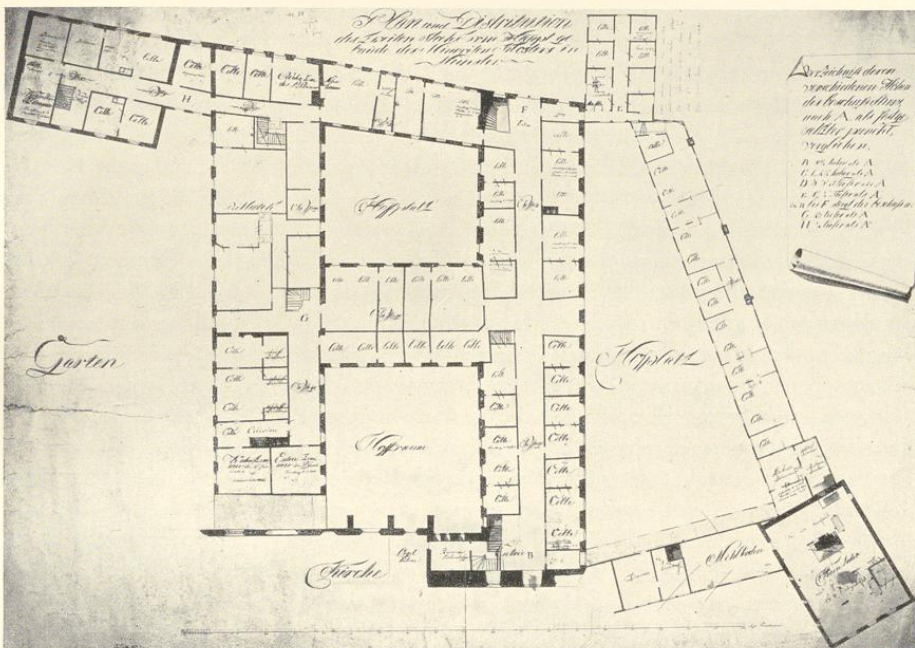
Grundriß des Obergeschosses, vor 1803
